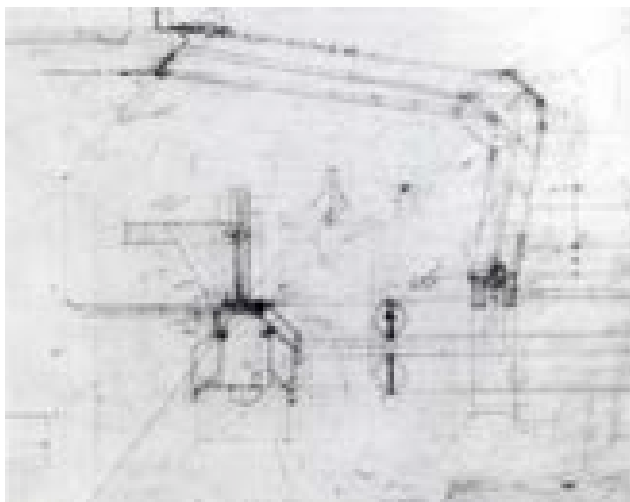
Dettaglio del Johnson Wax Building, il claristorio ¹⁸⁴
